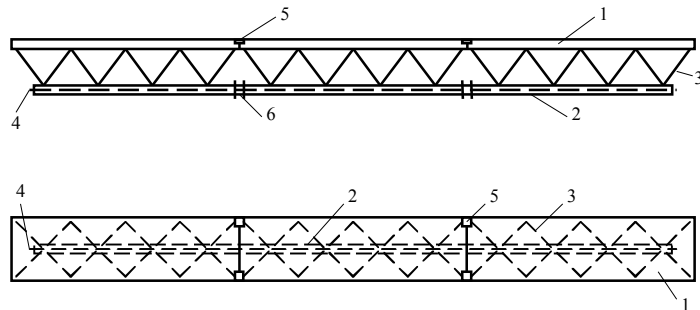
Попередньо напружена стале залізобетонна структурна плита, зібрана з лінійних елементів: 1 – залізобетонна плита; 2 – нижній пояс із сталеві труби; 3 – розкоси; 4 – попередньо напружена арматура; 5 – закладні деталі для з'єднання плит; 6 – стик, що поєднує елементи пояса.
